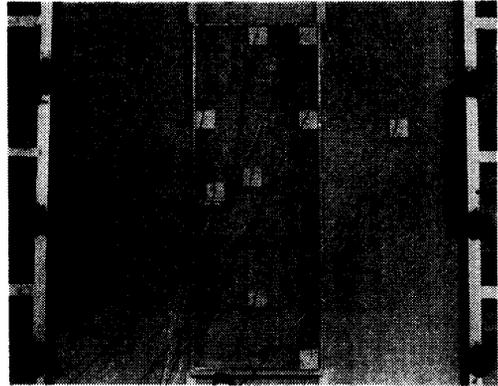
B級仕切用アスベストサンドイッチ扉試験体 (Specimen 25)
